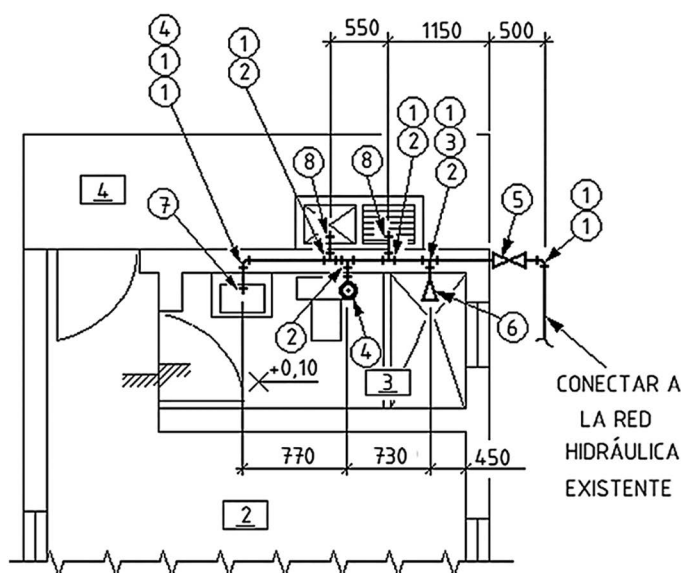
Plano de instalaciones hidráulicas del baño
